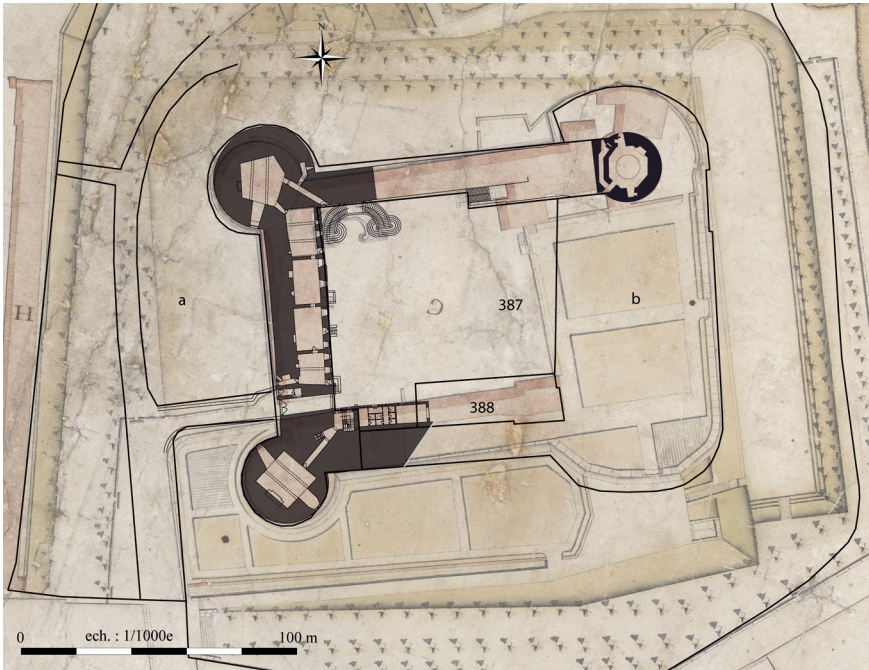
Pontivy, château des Rohan. Recalage au 100° des plans de la tour nord-est, du plan topographique du château et du cadastre actuel, sur le plan de 1781 (DAO Jocelyn Martineau, d'après Yannick Rose, 1987, le cadastre actuel et le plan des Archives municipales Pontivy, 5 Fi 1)
